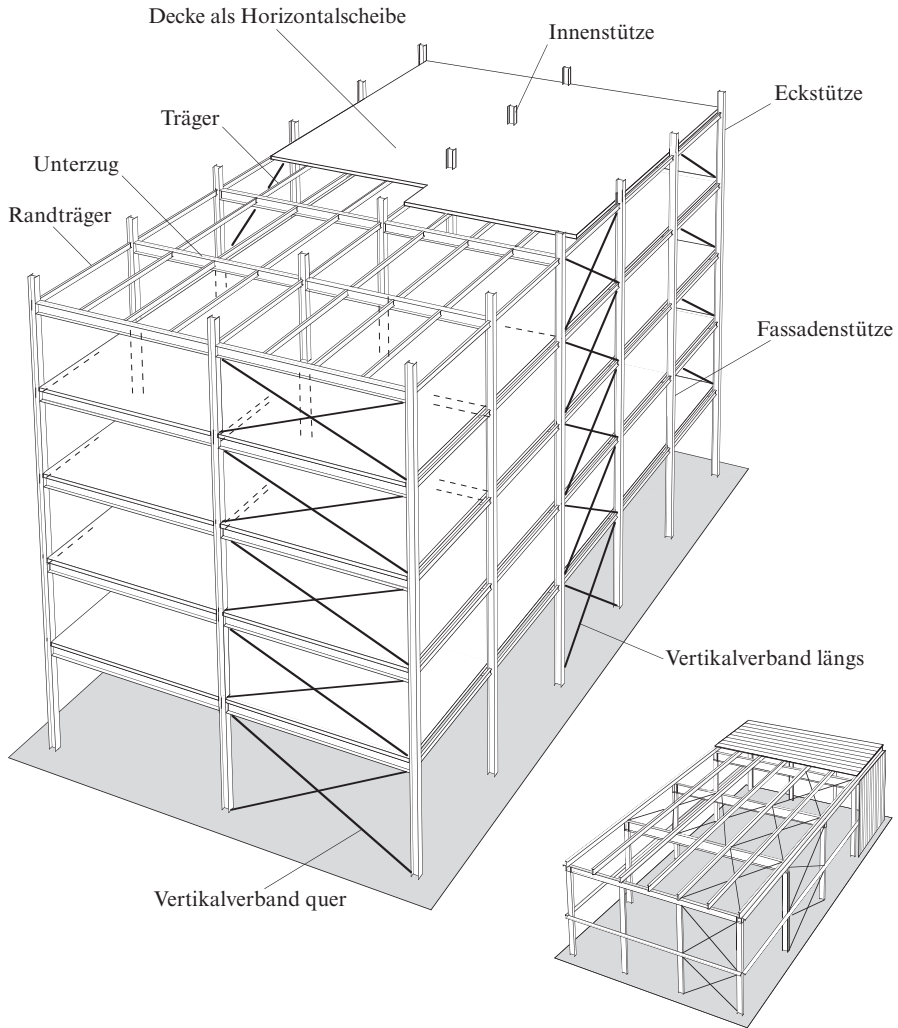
Konstruktionselemente eines Geschossbaus.
